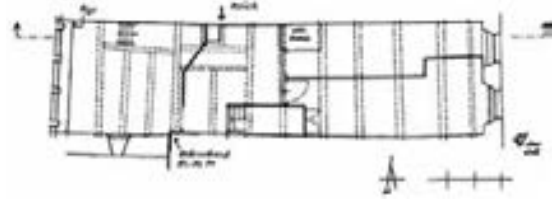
Villingen, Niedere Straße 38, Grundriss 1. Dach- geschoss.
